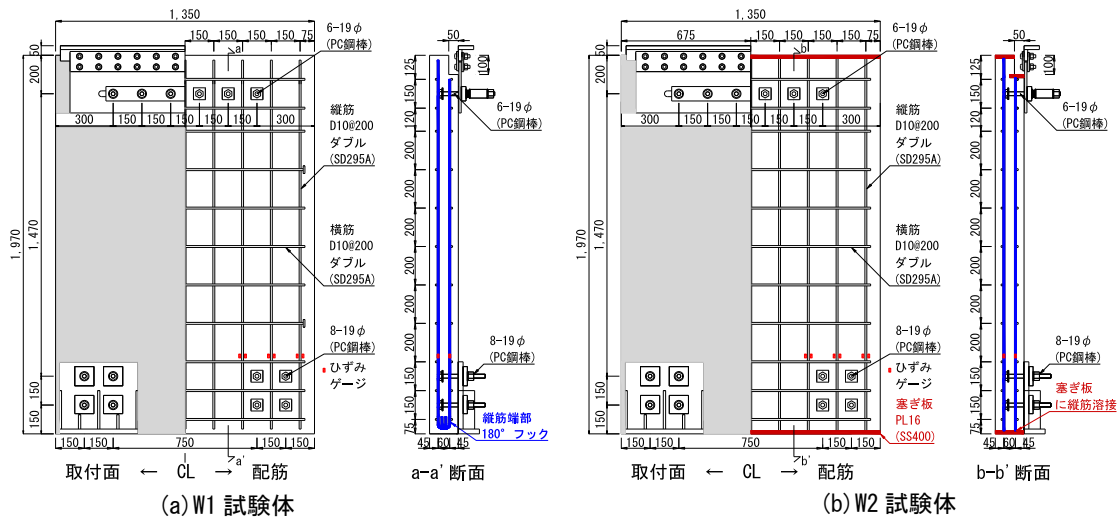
試験体の形状・寸法、配筋、及び縦筋ひずみ計測位置
